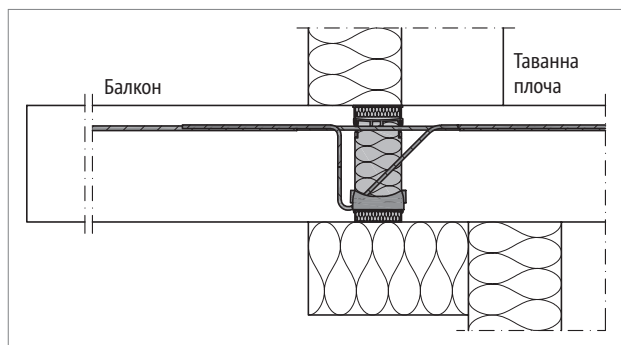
Schöck Isokorb® T mun KL и QL-VV: Балкон лежащ на две страни
